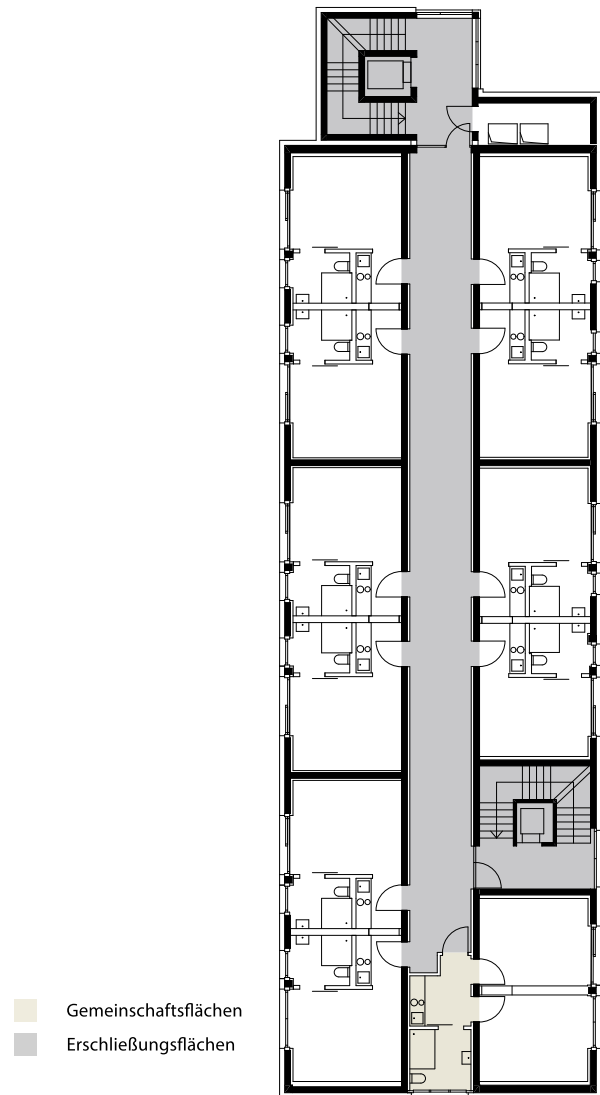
Grundriss Regelgrundriss, M. 1:300 [© BF Vario]
